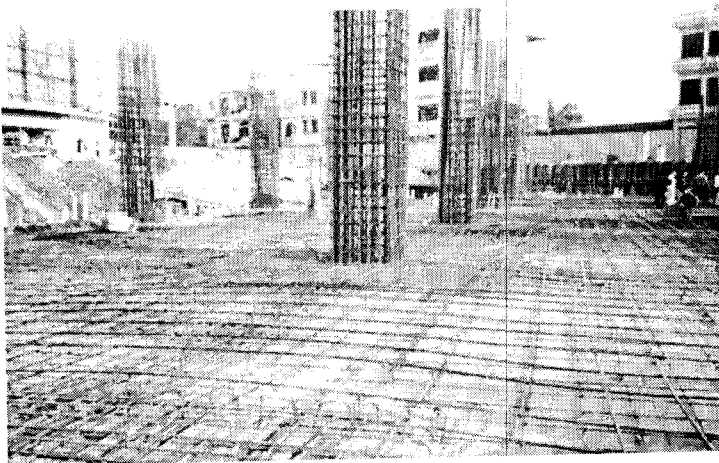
Hệ kết cấu dầm - sàn gara ngầm bằng cấu kiện bê tông ứng suất trước căng (Hà Nội)
